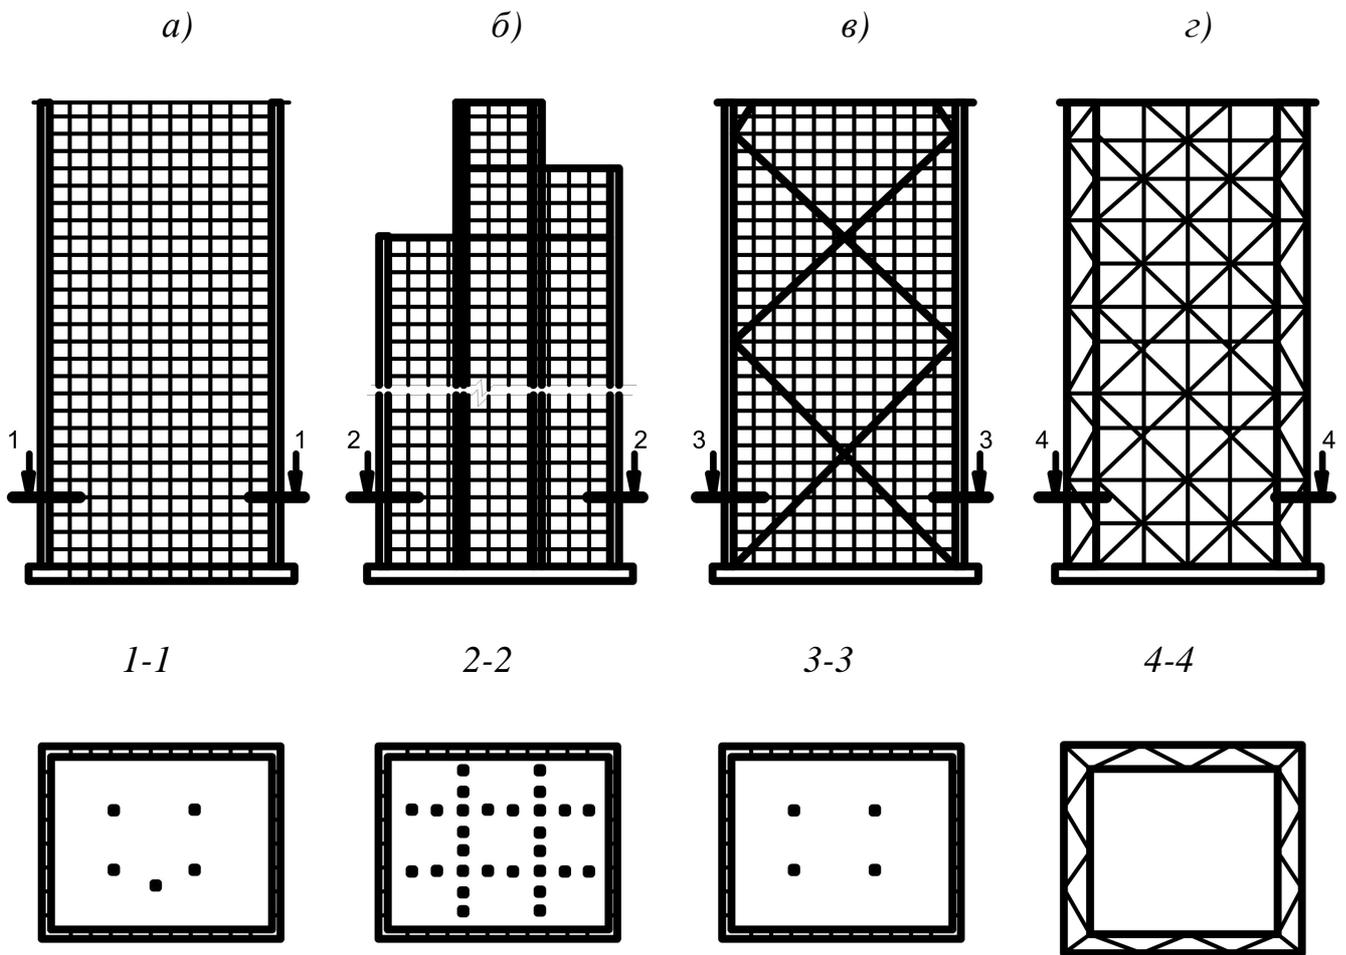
Конструктивные схемы высотных зданий с наружными жесткостными элементами (оболочковые здания) в виде: *а* – пространственной рамы («труба»); *б* – пространственной рамы с внутренними диафрагмами («пучок труб»); *в* – связевой системы в виде пространственной макрофермы; *г* – связевой системы в виде пространственной структурной конструкции
